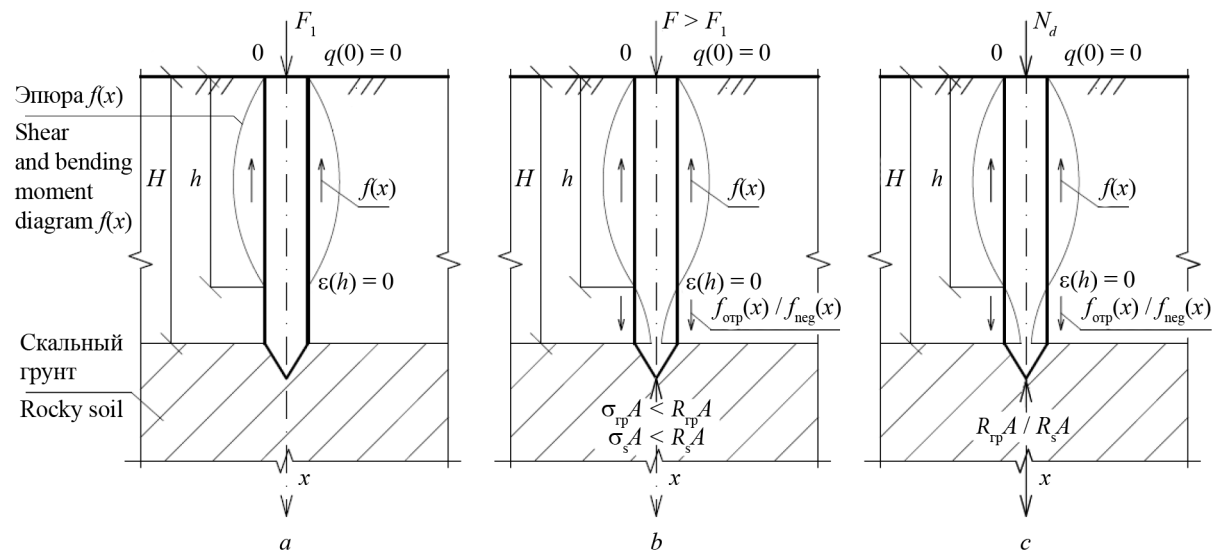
Варианты работы сваи-стойки в грунте основания: F — расчетная нагрузка (с учетом веса сваи); N_d — предельная нагрузка по несущей способности грунта основания; $f_{opr}(x)$ — отрицательные силы трения-сцепления
